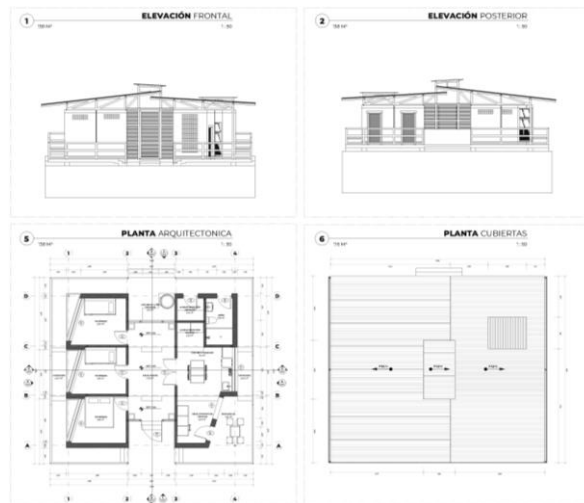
Planimetría Vivienda VRCPP Fase II
